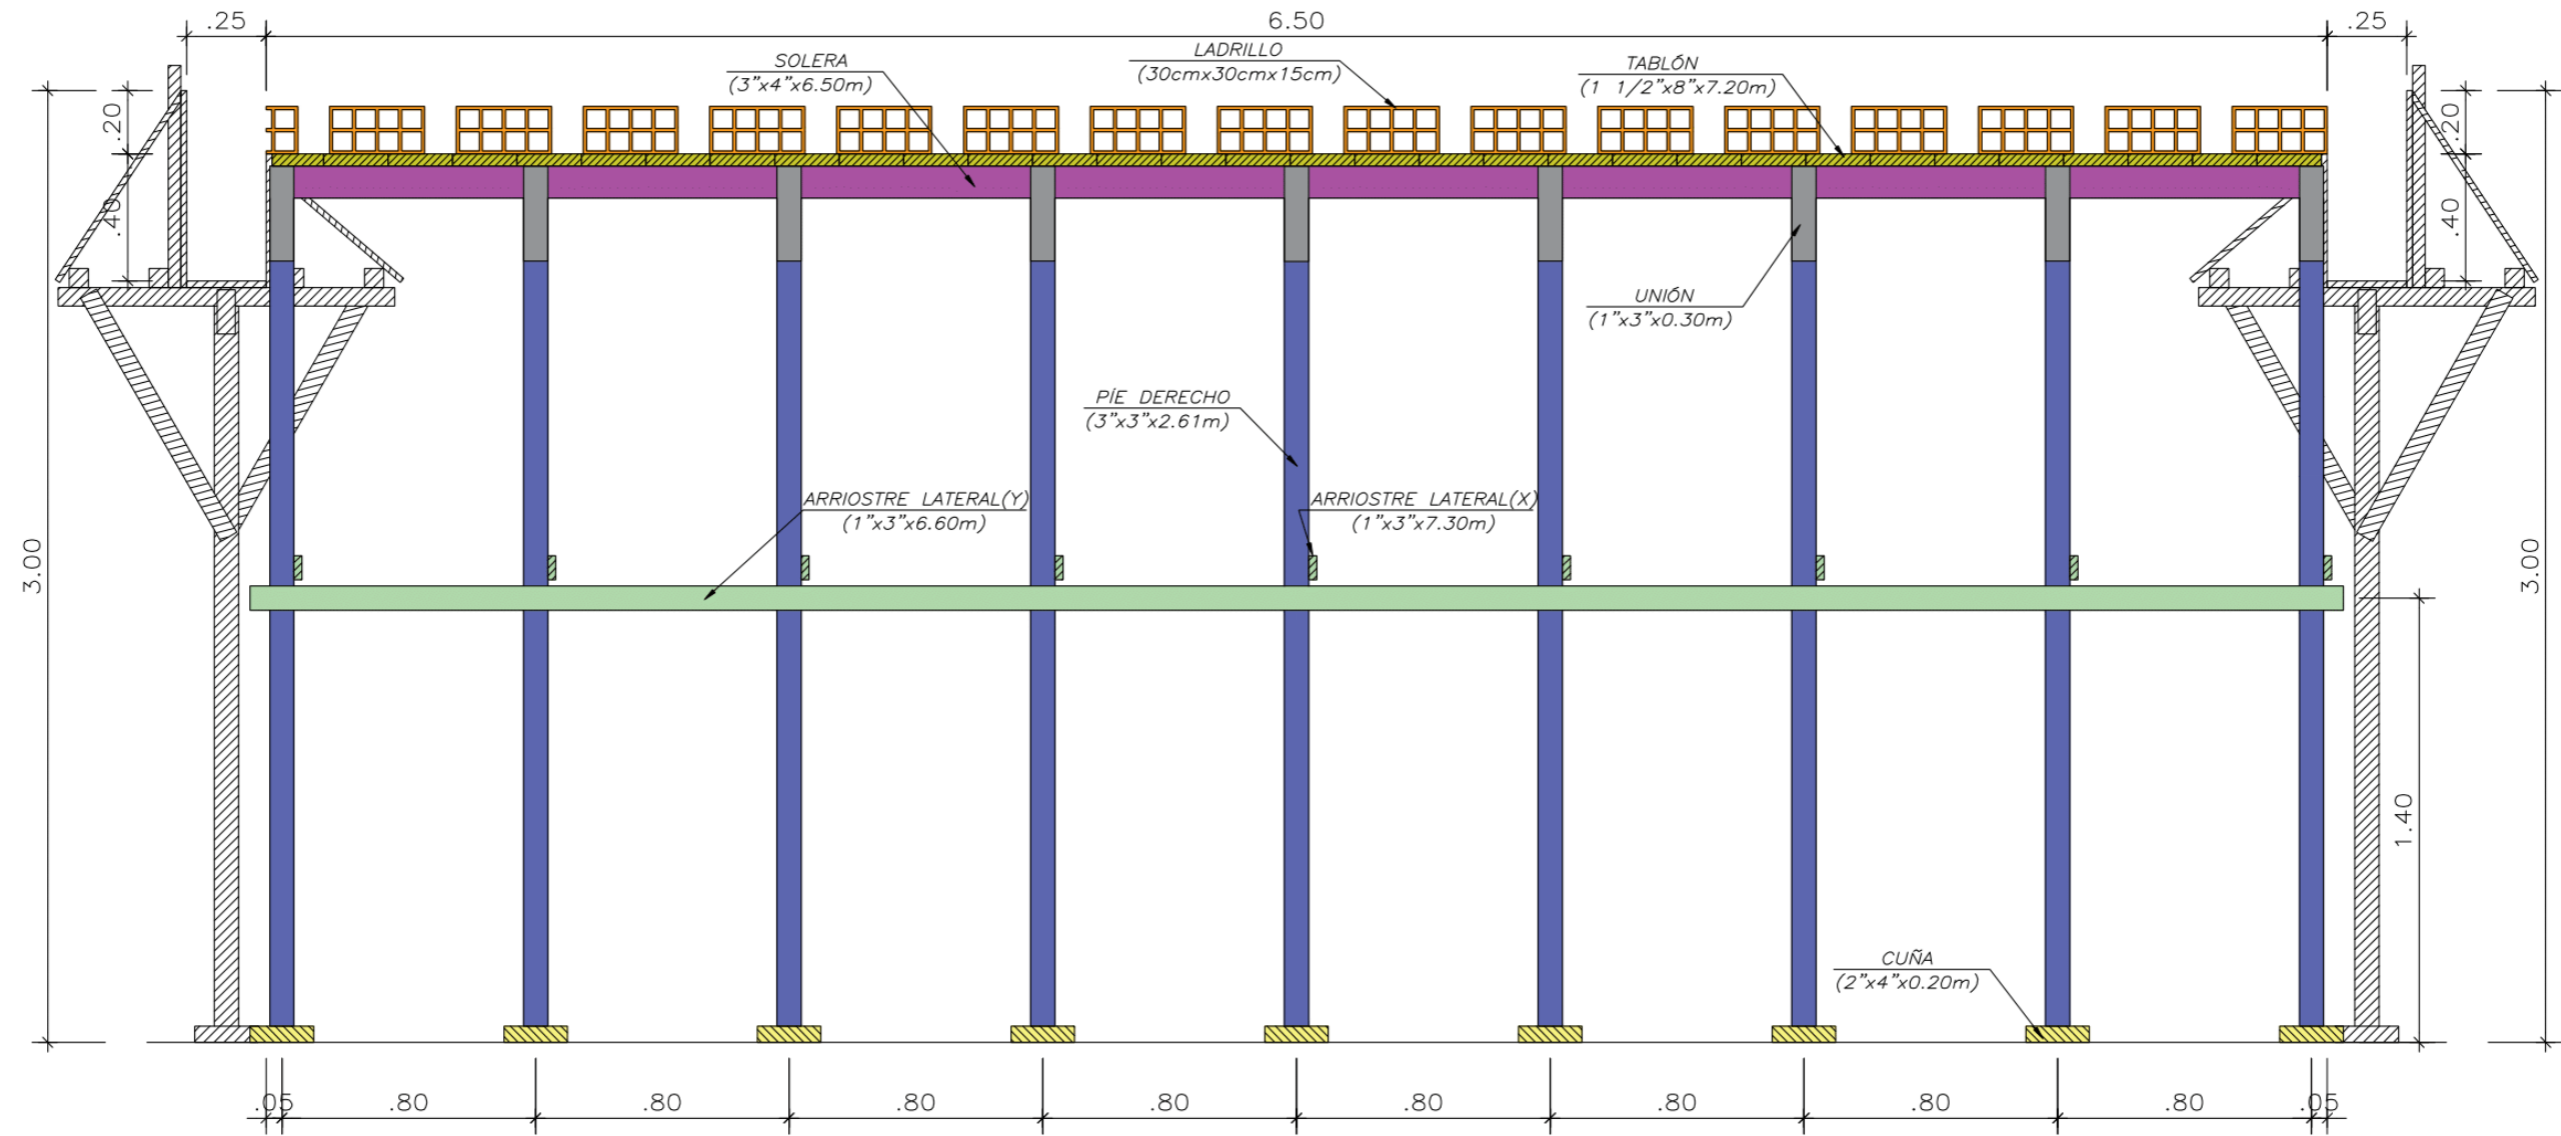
Corte Longitudinal D – D, para la Losa Aligerada Bidireccional Convencional.
